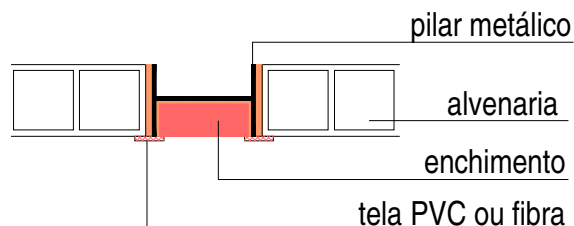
Proteções da estrutura para recebimento de revestimento
